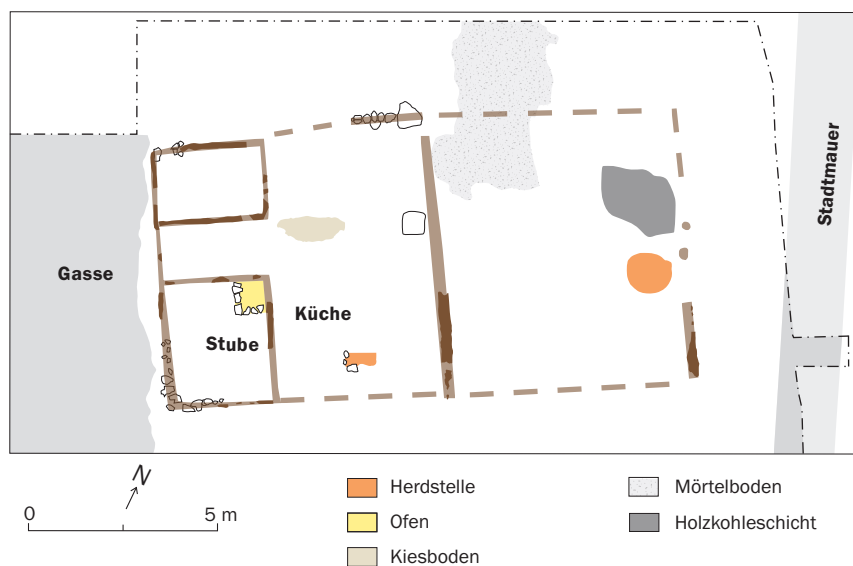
Altreu SO. Schematischer Grundriss des älteren Ständerbaus von Haus H 1. M. 1:200.
